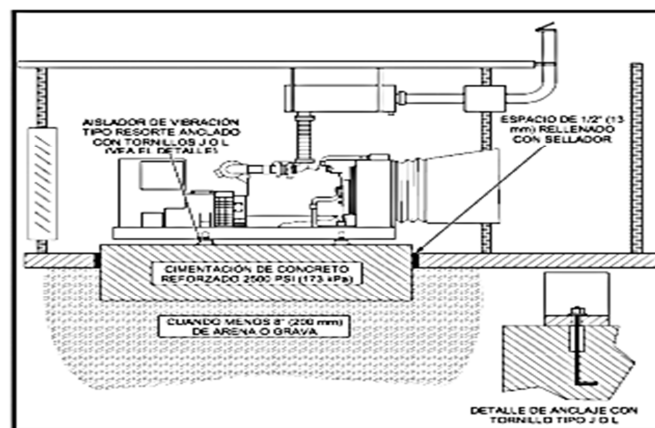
Cimentación y aislamiento de la vibración.²⁵
